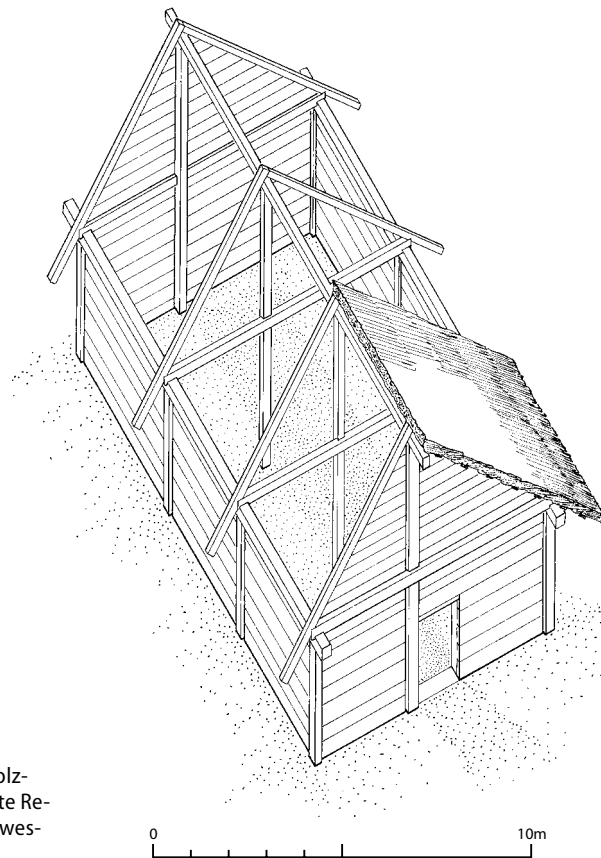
Worb, Kirche. Holzpfeifenbau. Vereinfachte Rekonstruktion. Von Nordwesten. M. 1:200.
